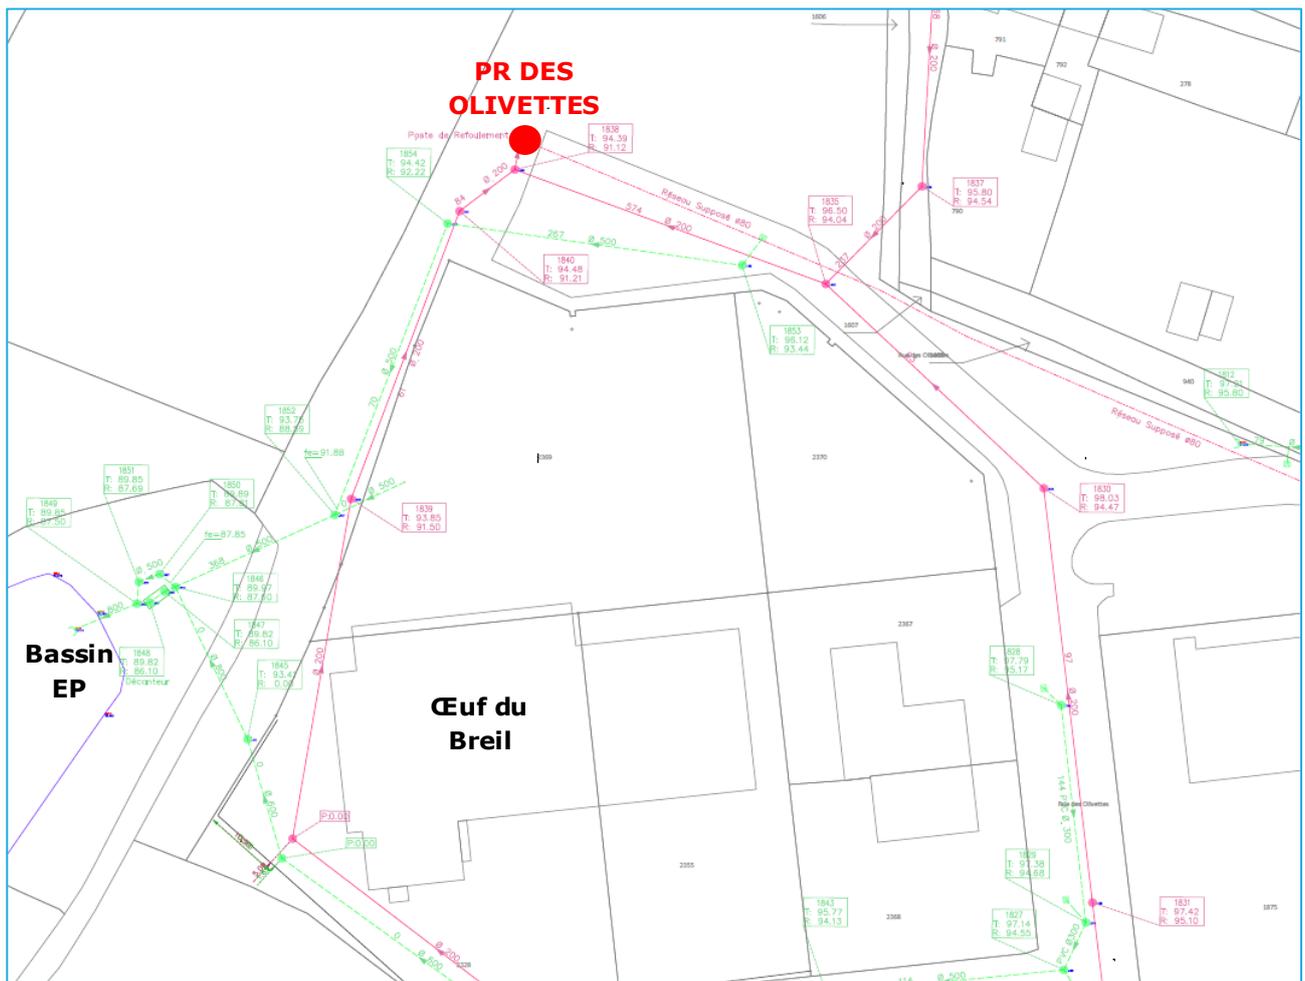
Plan du réseau de collecte au niveau de la ZA des Olivettes
